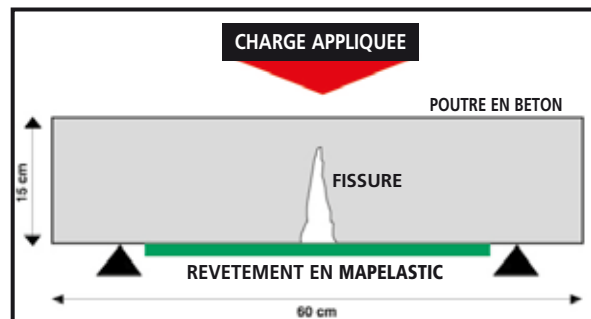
Protection avec Mapelastic d'une fissure en sous-face d'une poutre en béton soumise à une sollicitation de flexion.
